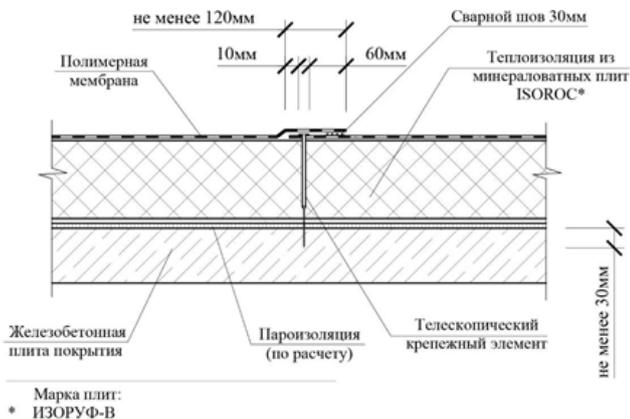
Устройство гидроизоляционного кровельного ковра из полимерной мембраны.
